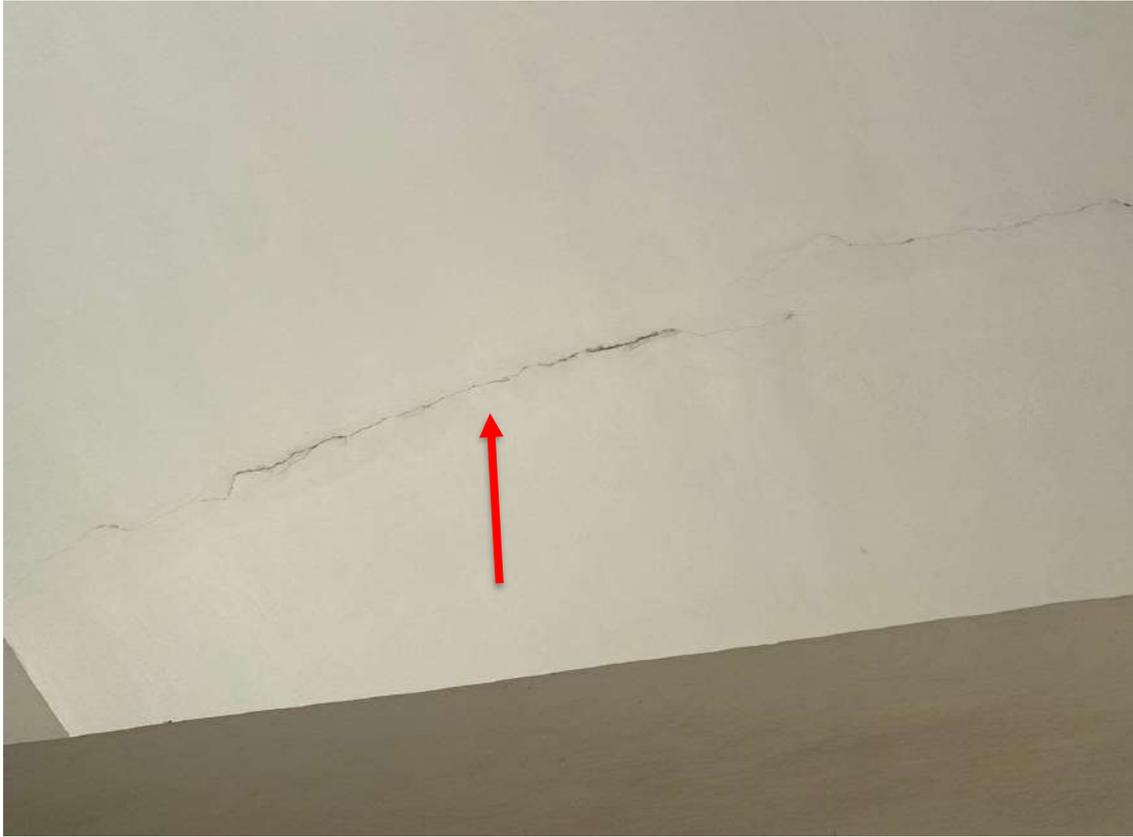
Trinca em elemento de concreto armado (em forma de arco/abóbadas).
